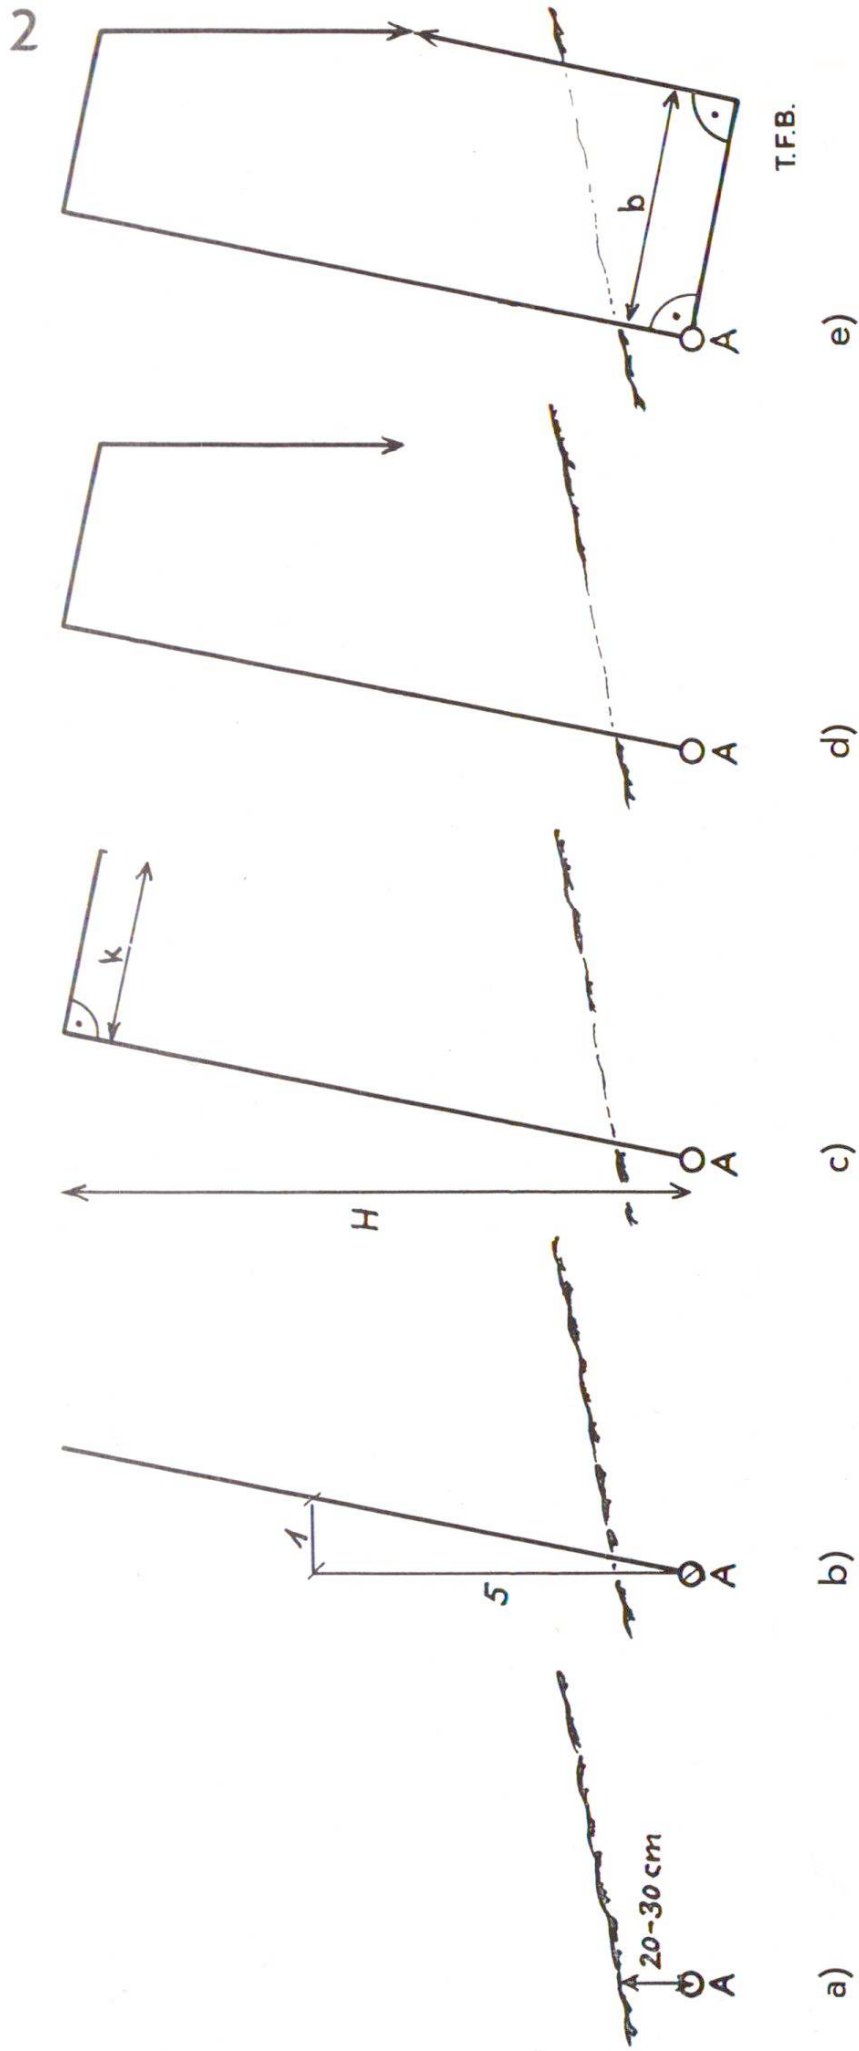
Détermination d'un mur de soutènement ou de revêtement. Fondation y relative voir tableau 2
